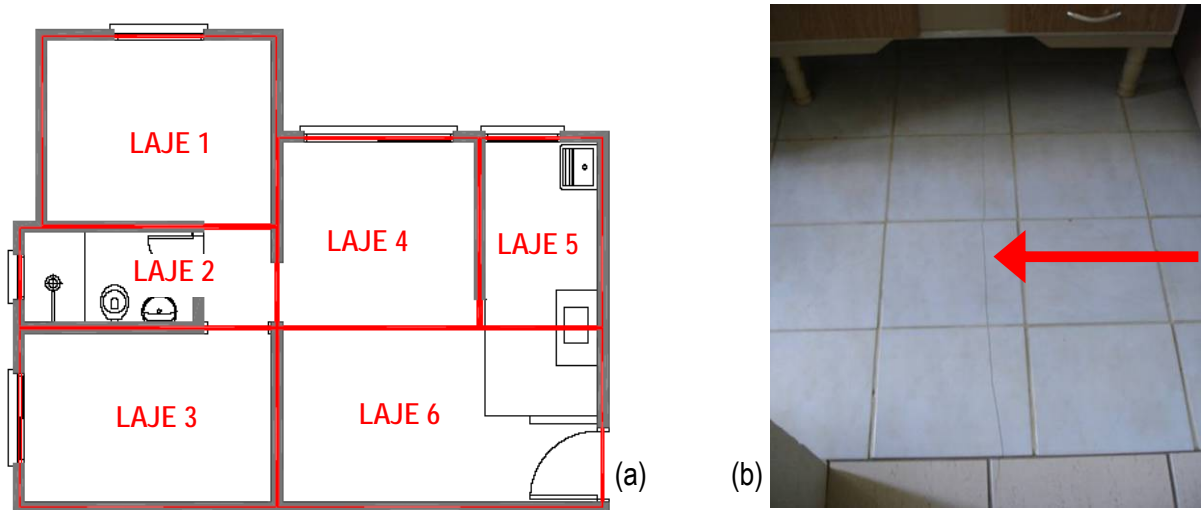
(a) croqui da disposição dos painéis de lajes e (b) exemplo de fissura no piso cerâmico
